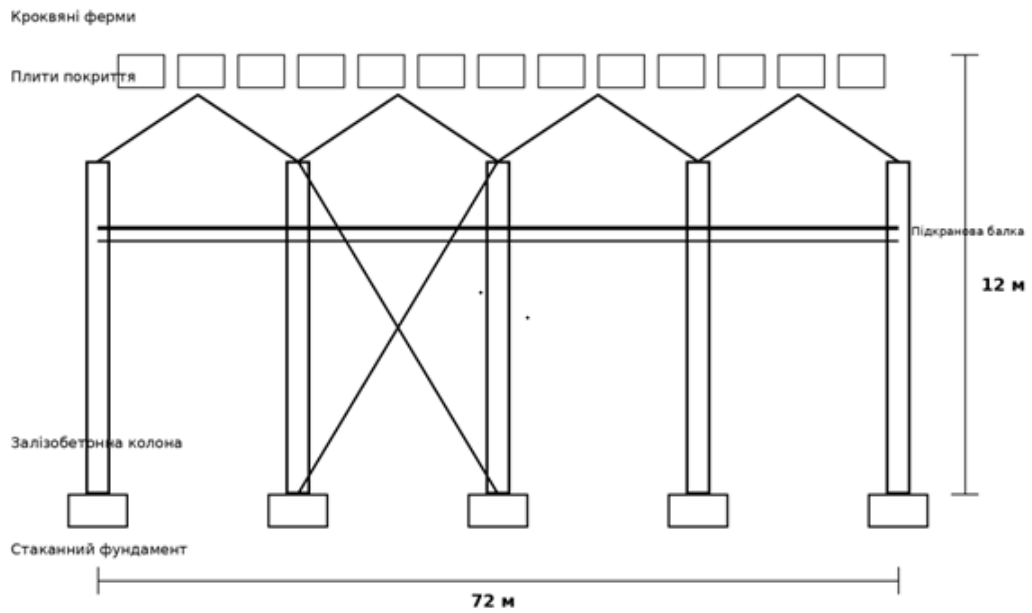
Конструктивна схема каркаса виробничого корпусу
